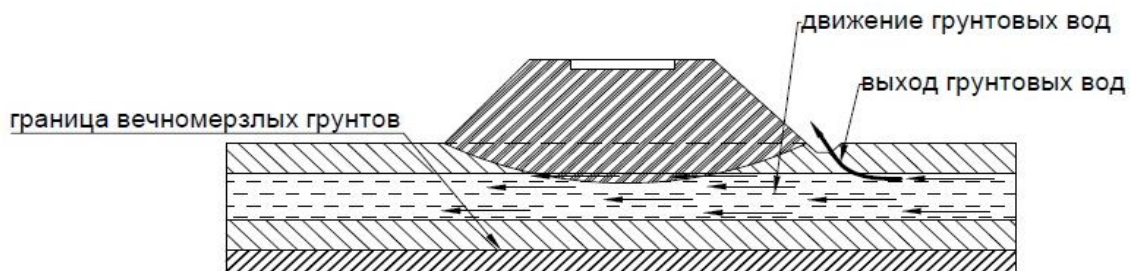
Схема движения грунтовых вод под насыпью из дренирующих грунтов
